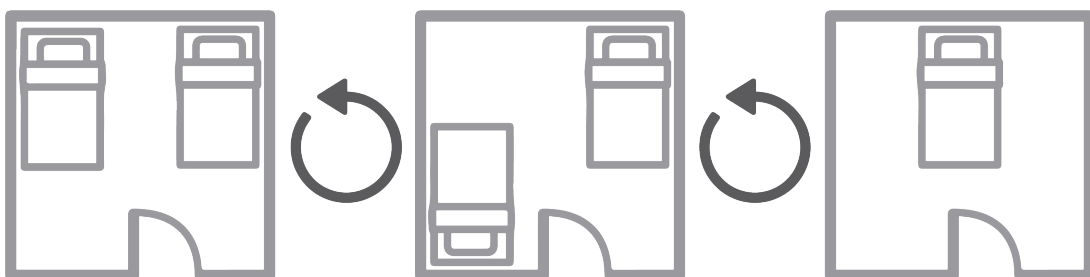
Diagrama de planta libre Paper Log House. Elaboración: Autores.
